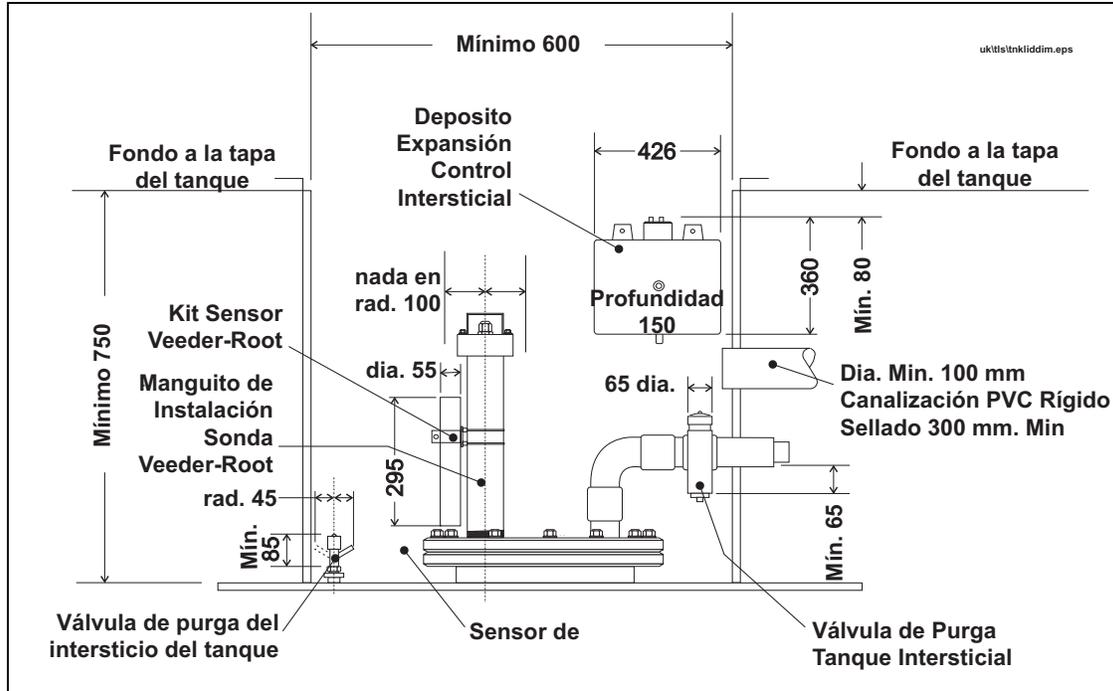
Cámara de acceso a la tapa del tanque - Dimensiones críticas
